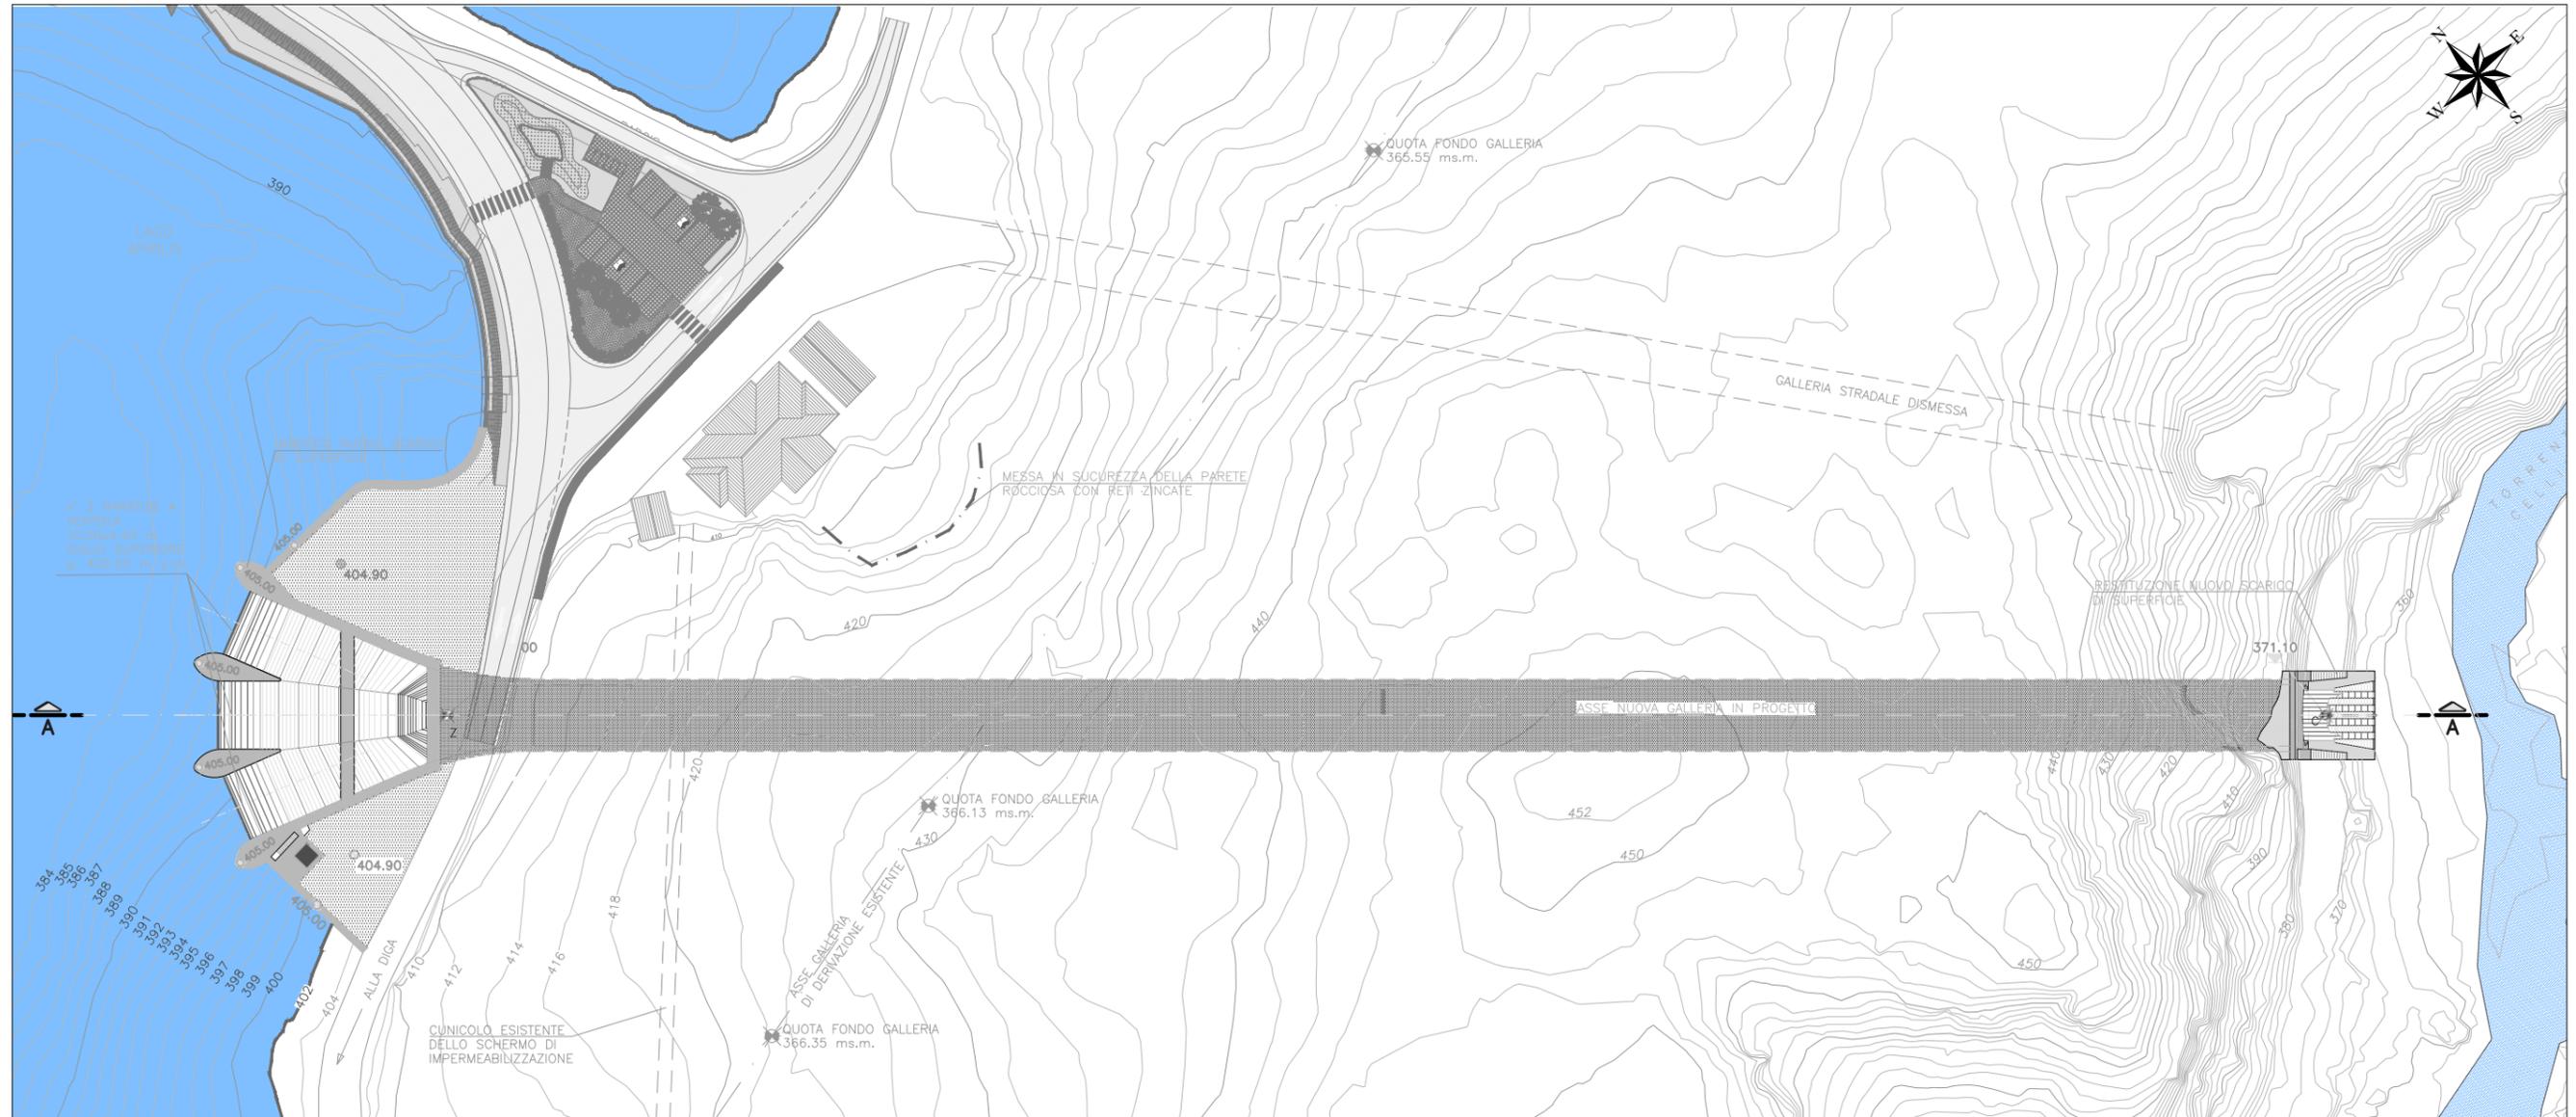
(1di3) Planimetria di base del manufatto di imbocco
